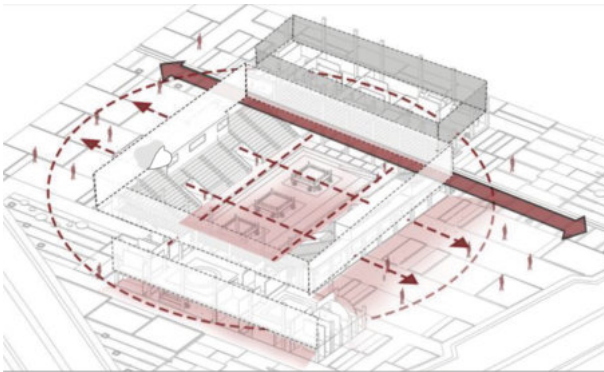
Distribución funcional de la planta arquitectónica
